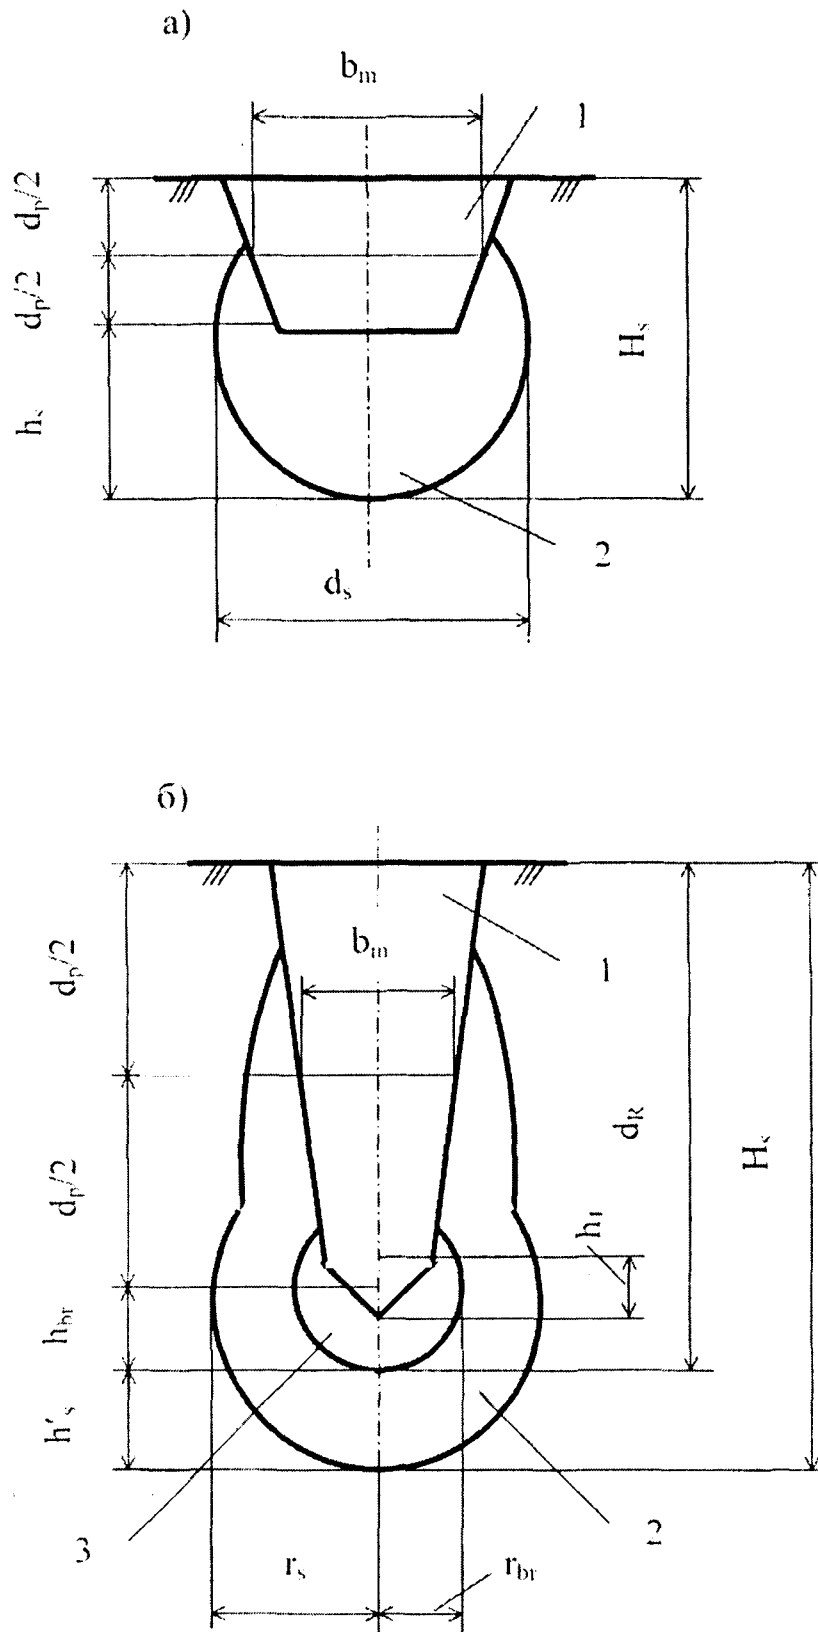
Схемы фундаментов в вытрамбованных котлованах.
